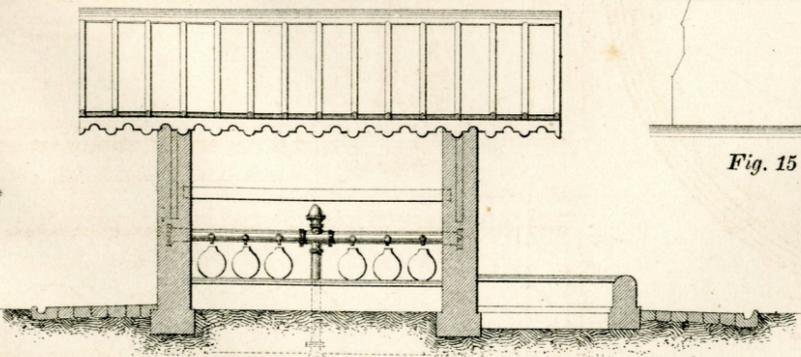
Sezione longitudinale secondo A B. - 1 a 100.
